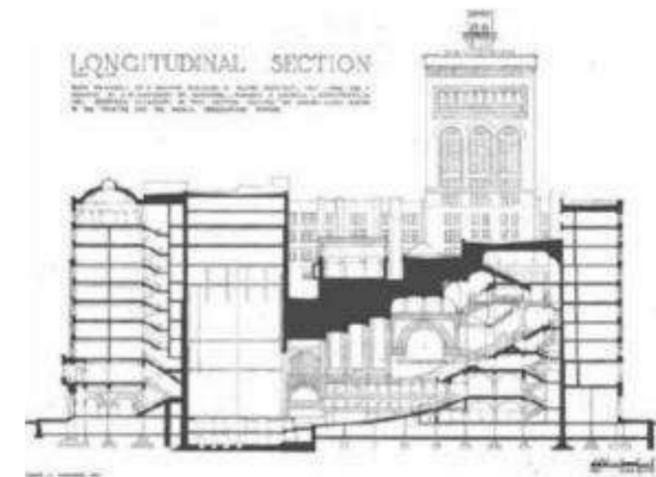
Sección longitudinal, Auditorium Building, Louis Sullivan. 1889.
